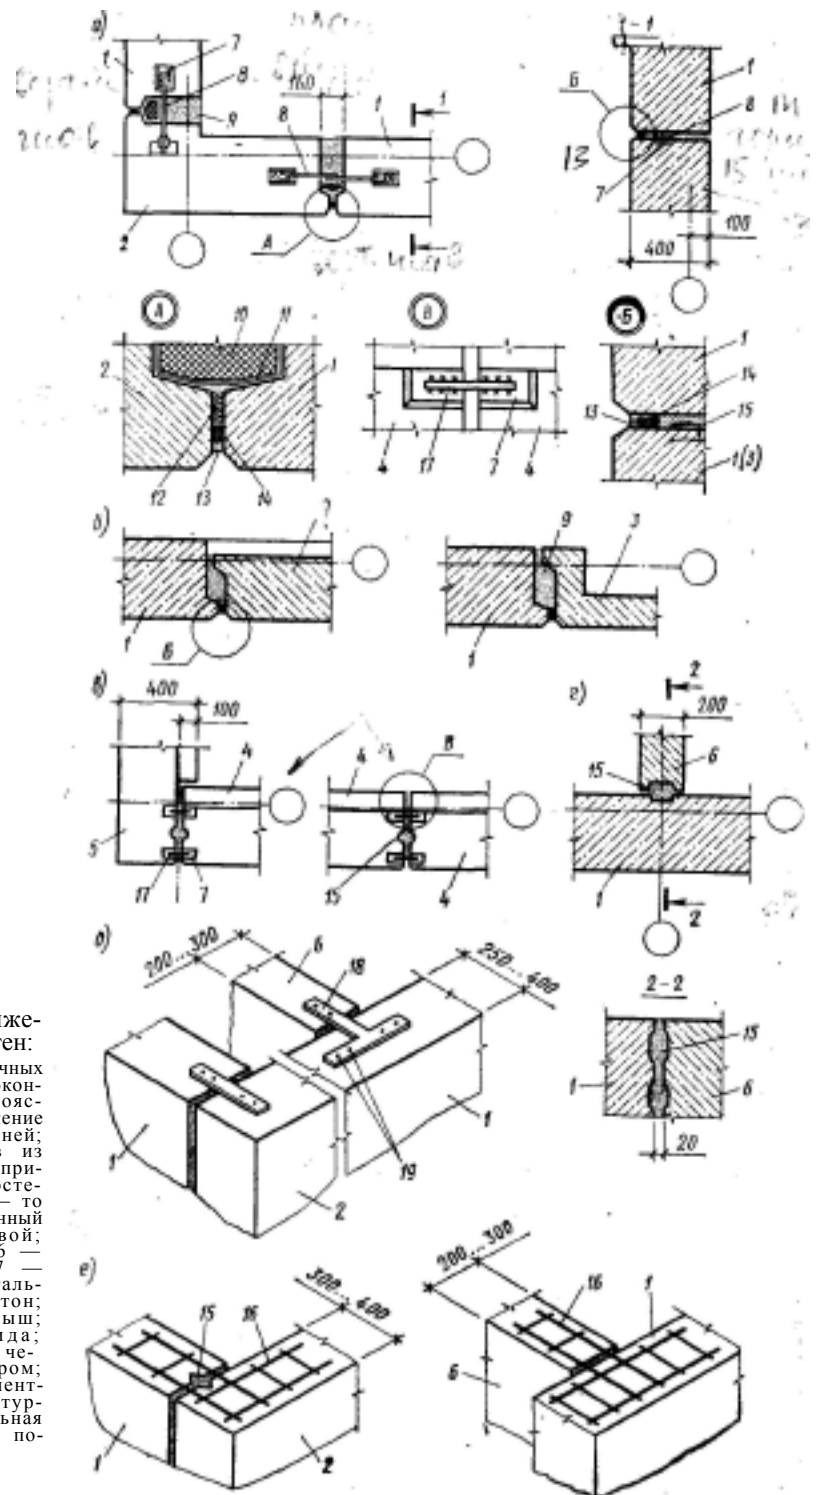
Узлы сопряжений блоквй наружных стен:
